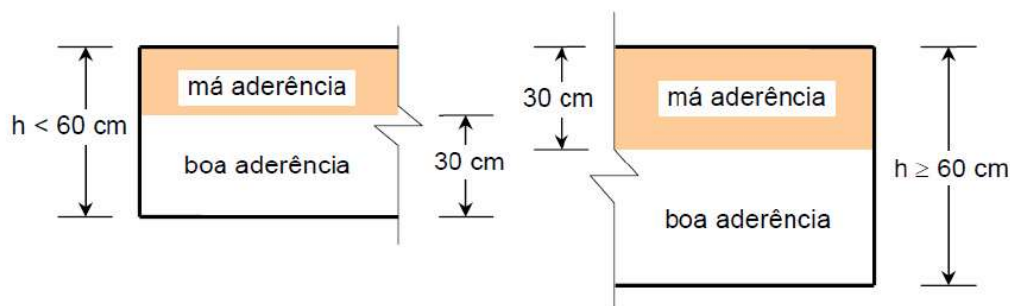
Situações de boa e má aderência para armaduras horizontais
